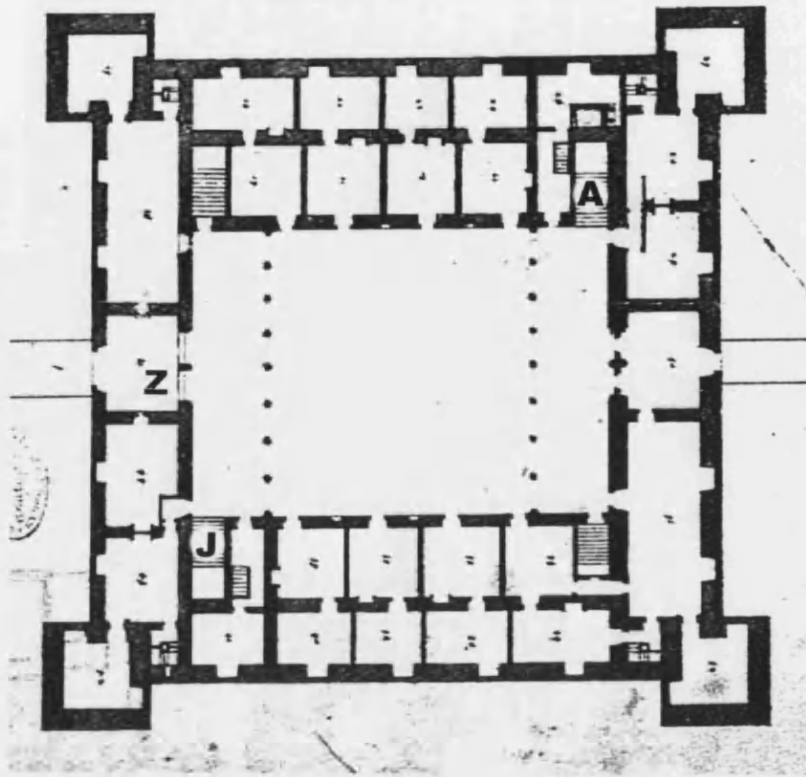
Planta baja de El Pardo. Hacia 1600.* Archivo General de Palacio, Madrid.
